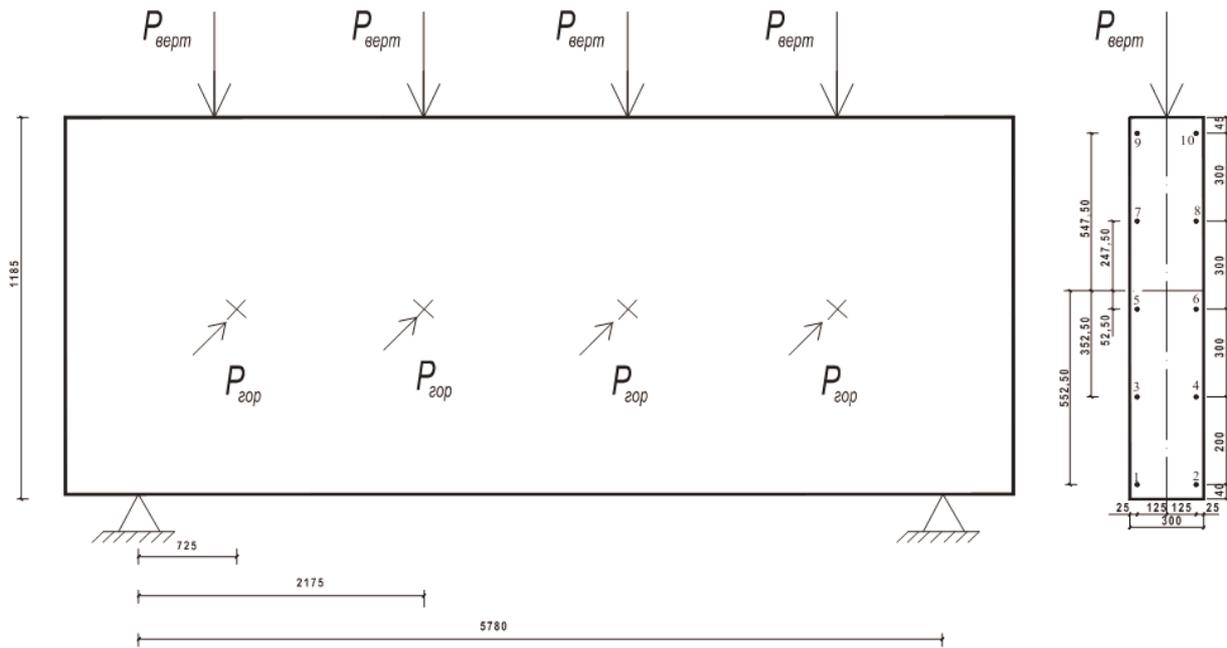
Схема испытания однослойной стеновой панели на совместное действие вертикальной и горизонтальной нагрузок ПС 600.12.30 (армирование панели класса А400 10 Ø 6 мм)
